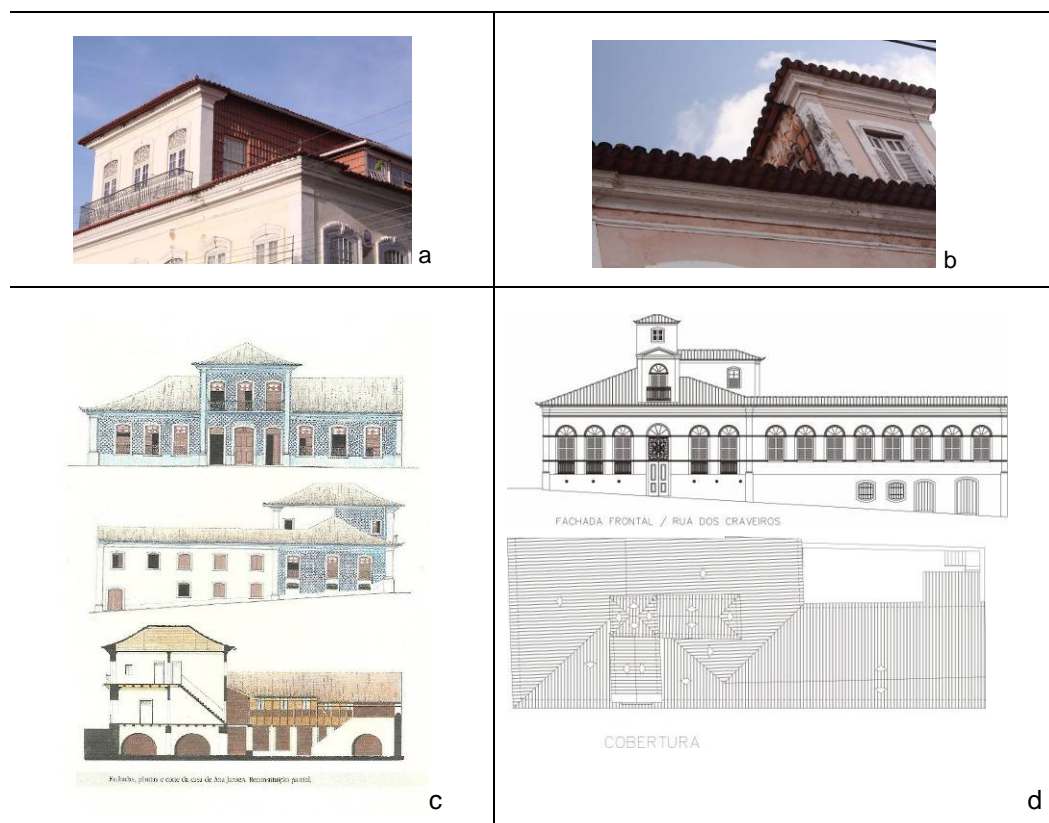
a) e b) Parede lateral do mirante revestida com telha cerâmica; c) Fachadas e corte de mirante; d) Fachada e cobertura de mirante
